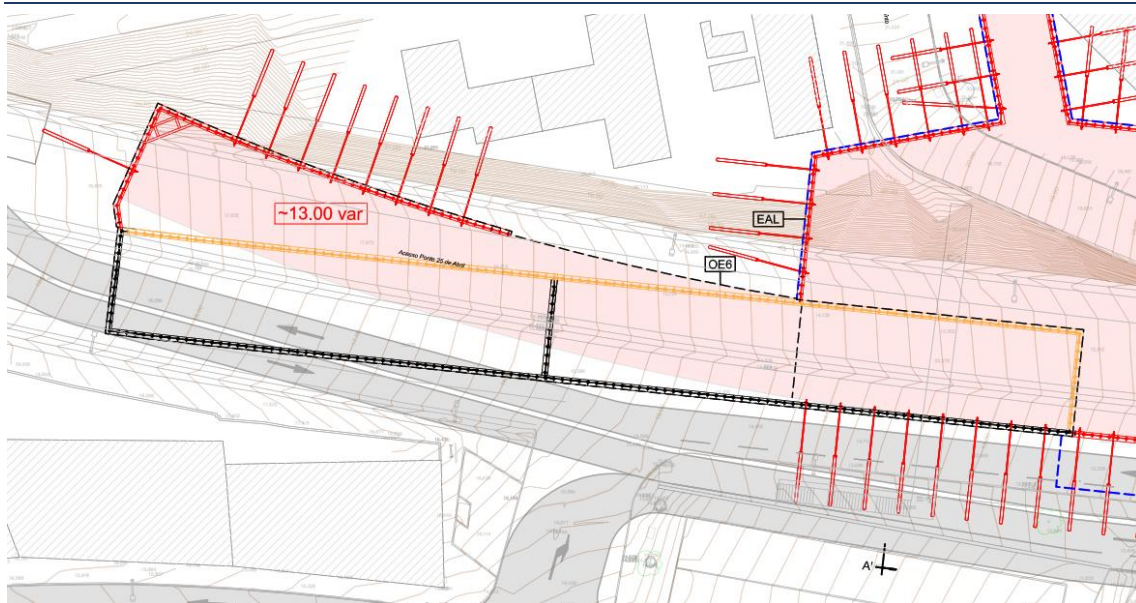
Planta de Dimensionamento Contenção Provisória – 3ª Fase de escavação
